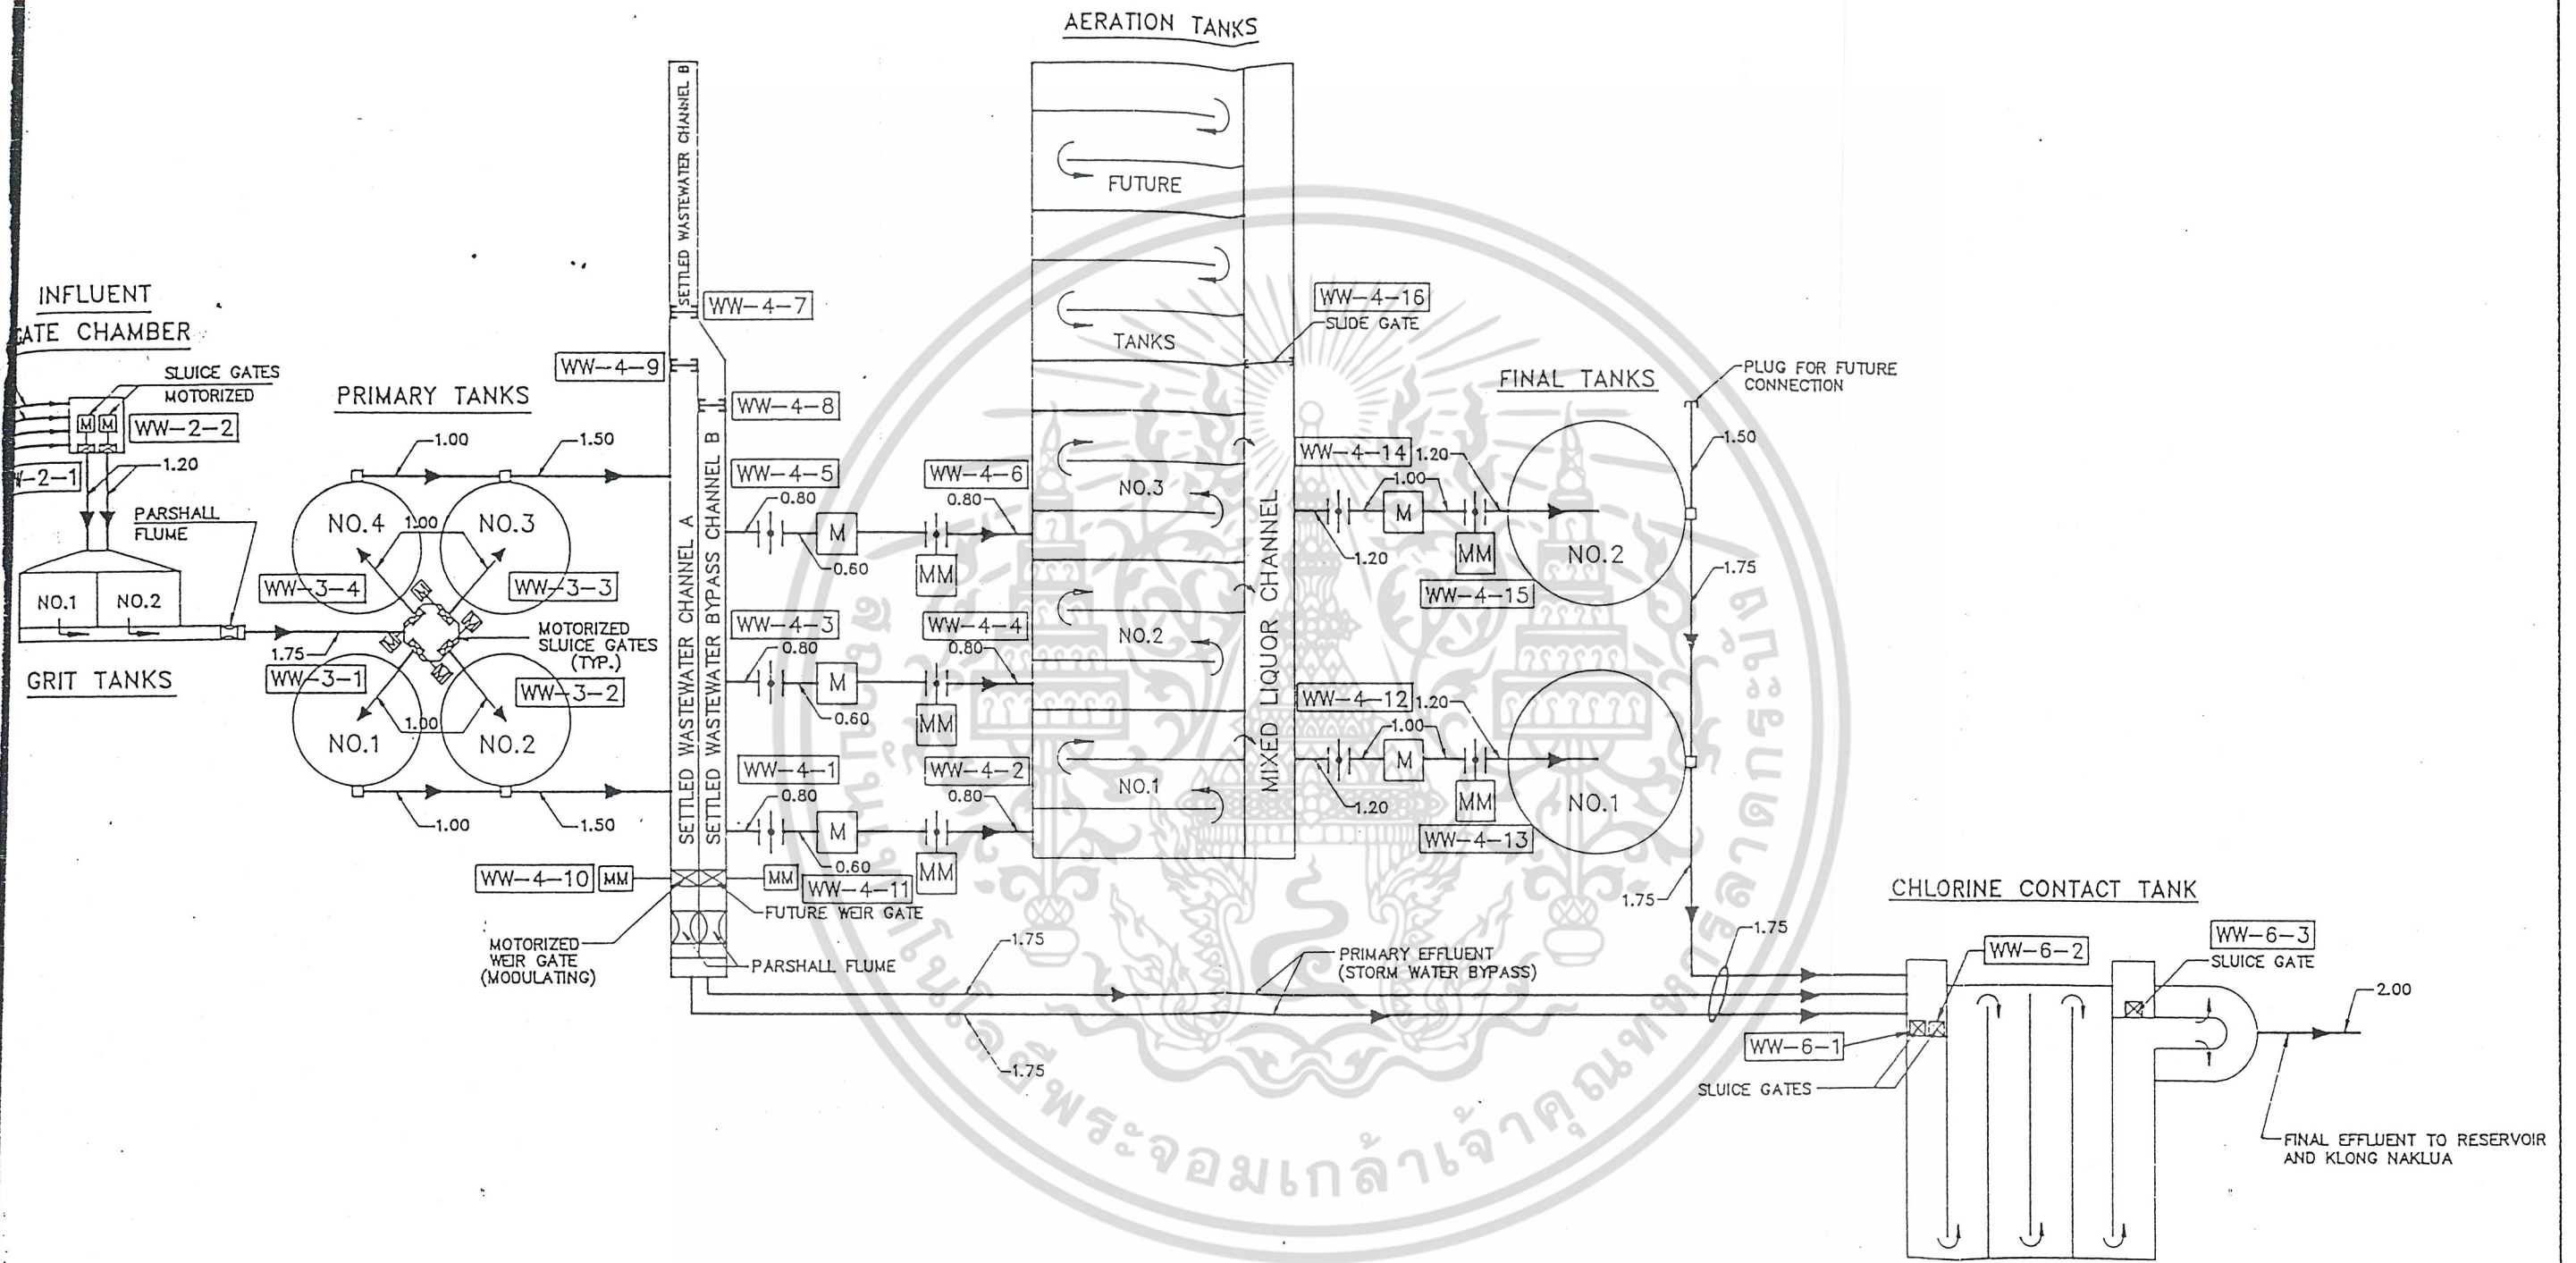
Site Plant Layout ของระบบบำบัดที่นาเกลือ
